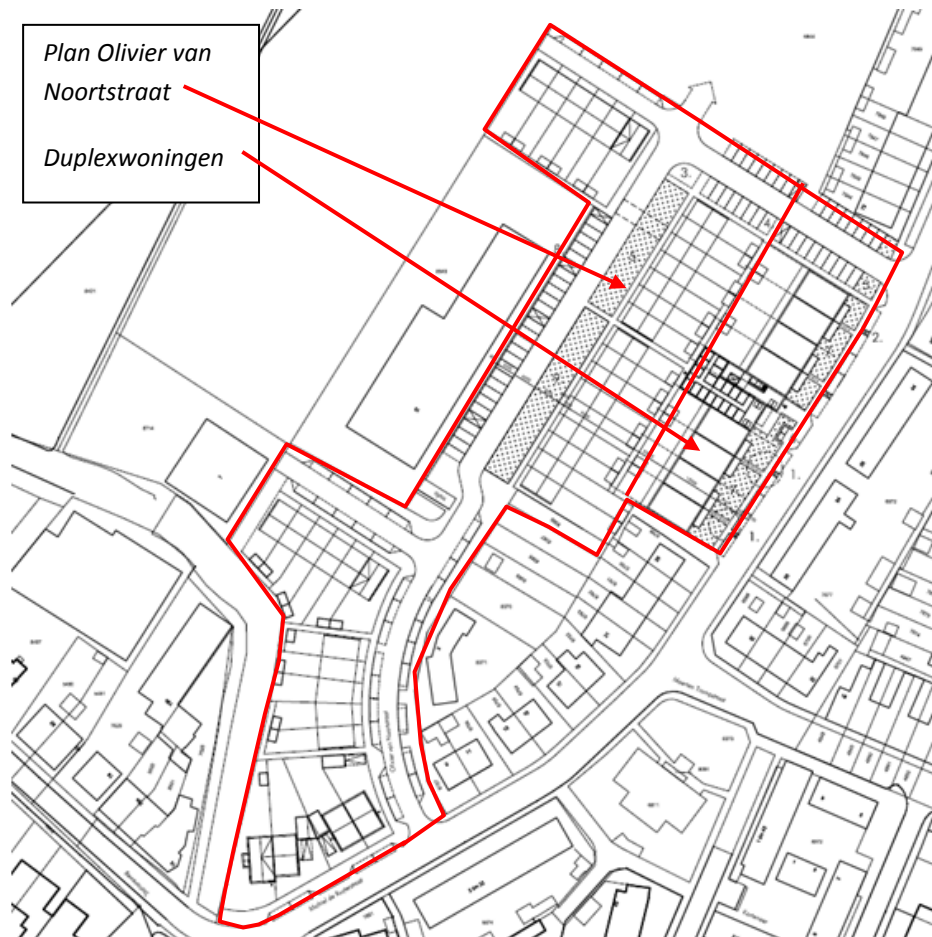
Stedenbouwkundig plan Schoonderbeek
